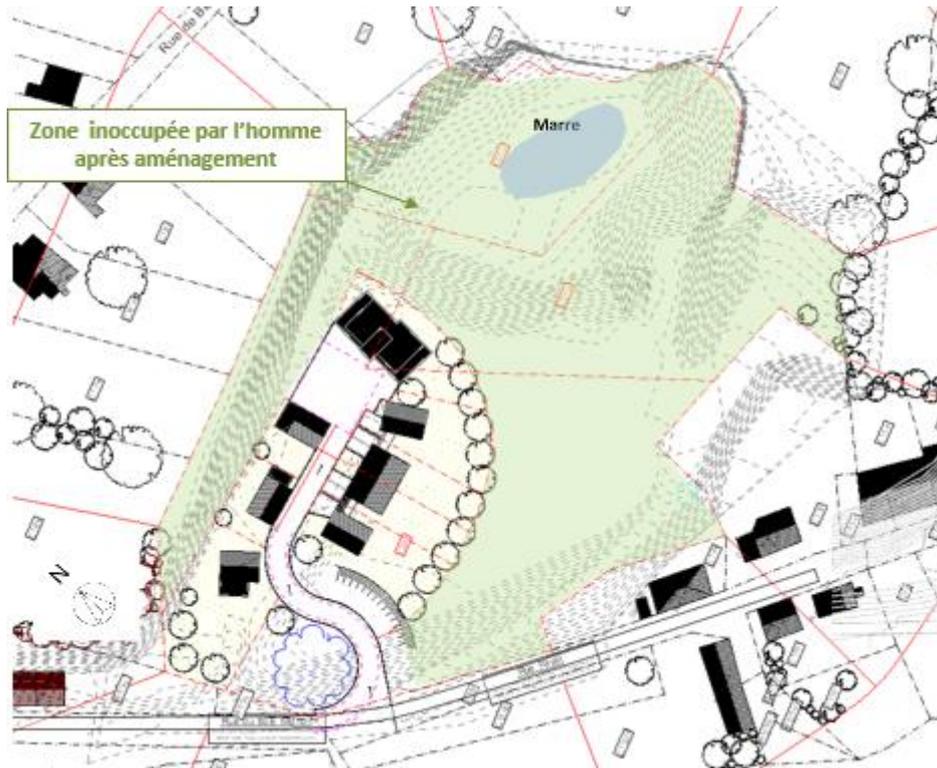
Plan d'implantation du projet (Source : DR(EA)²M, 2022)
